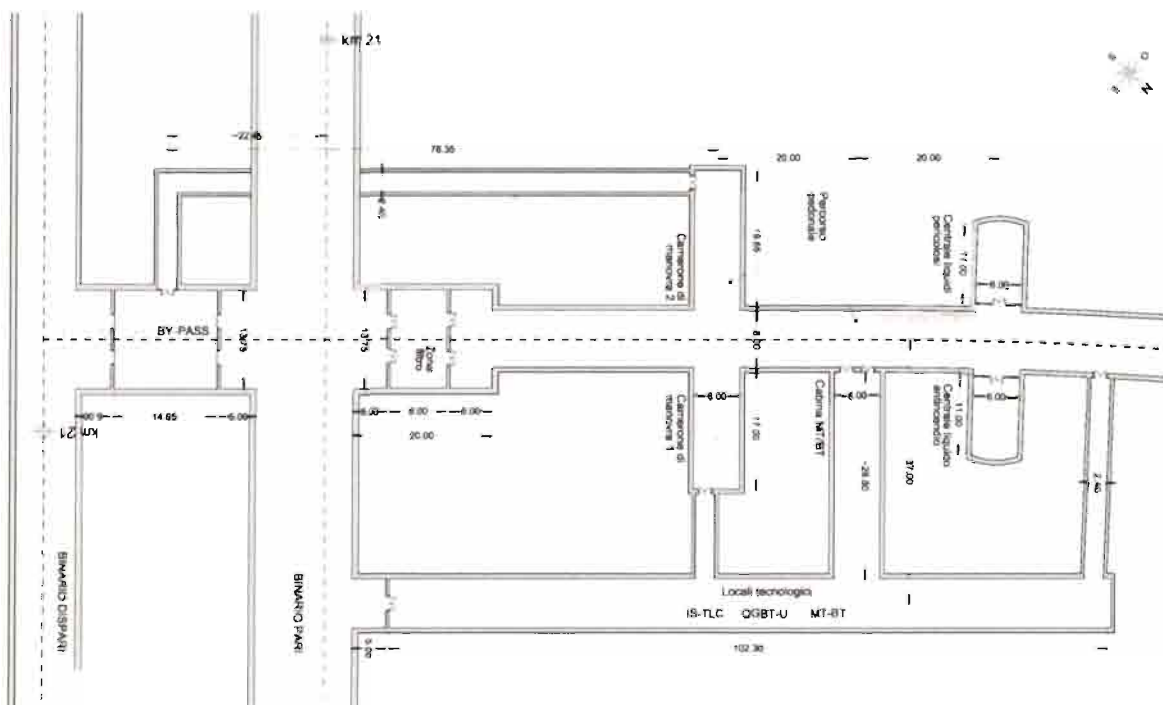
Stralcio planimetrico zona di innesto della discenderia di Chiusa con le gallerie di linea
